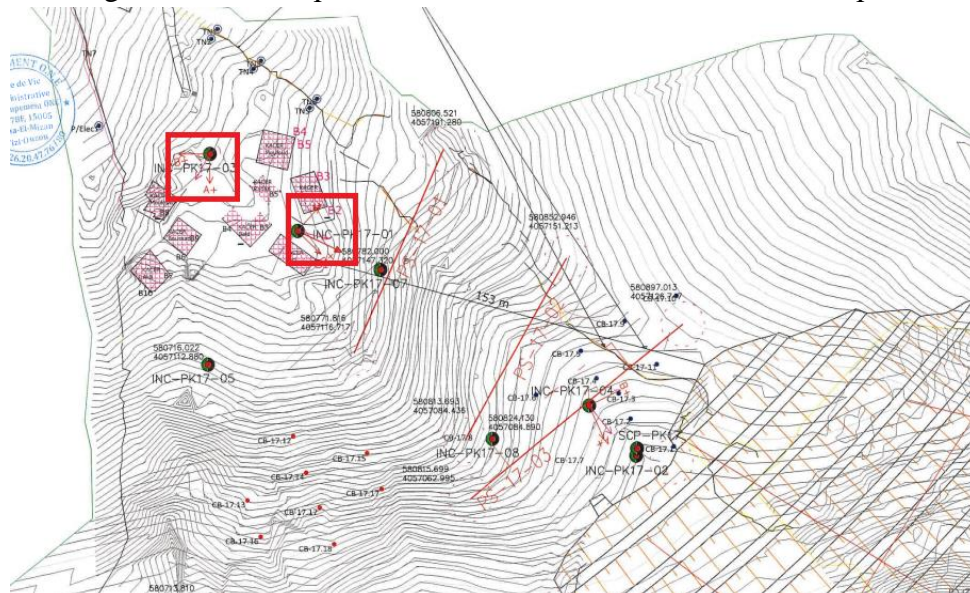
L'orientation des inclinomètres sur la vue en plan
